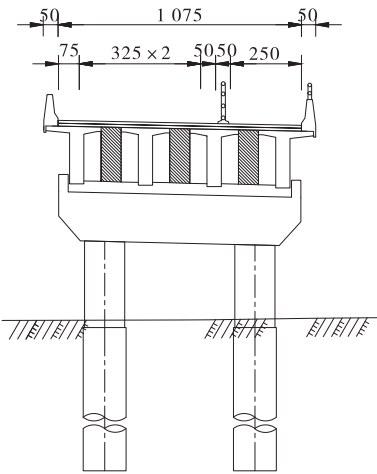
限速 60 km/h 时半幅桥梁横断面布置示意图(单位:cm)
